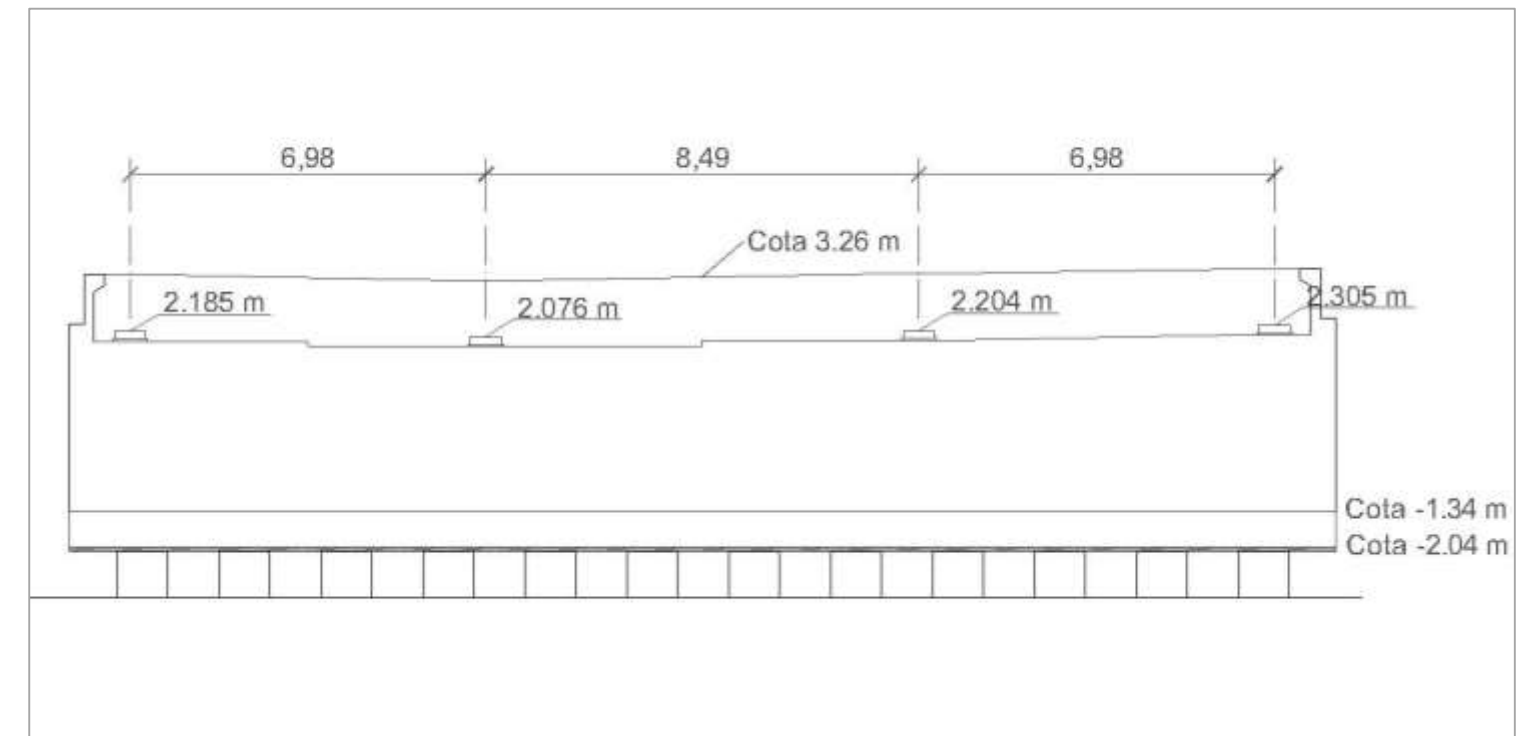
Alzado del estribo. Fuente: Elaboración propia con AutoCAD.
